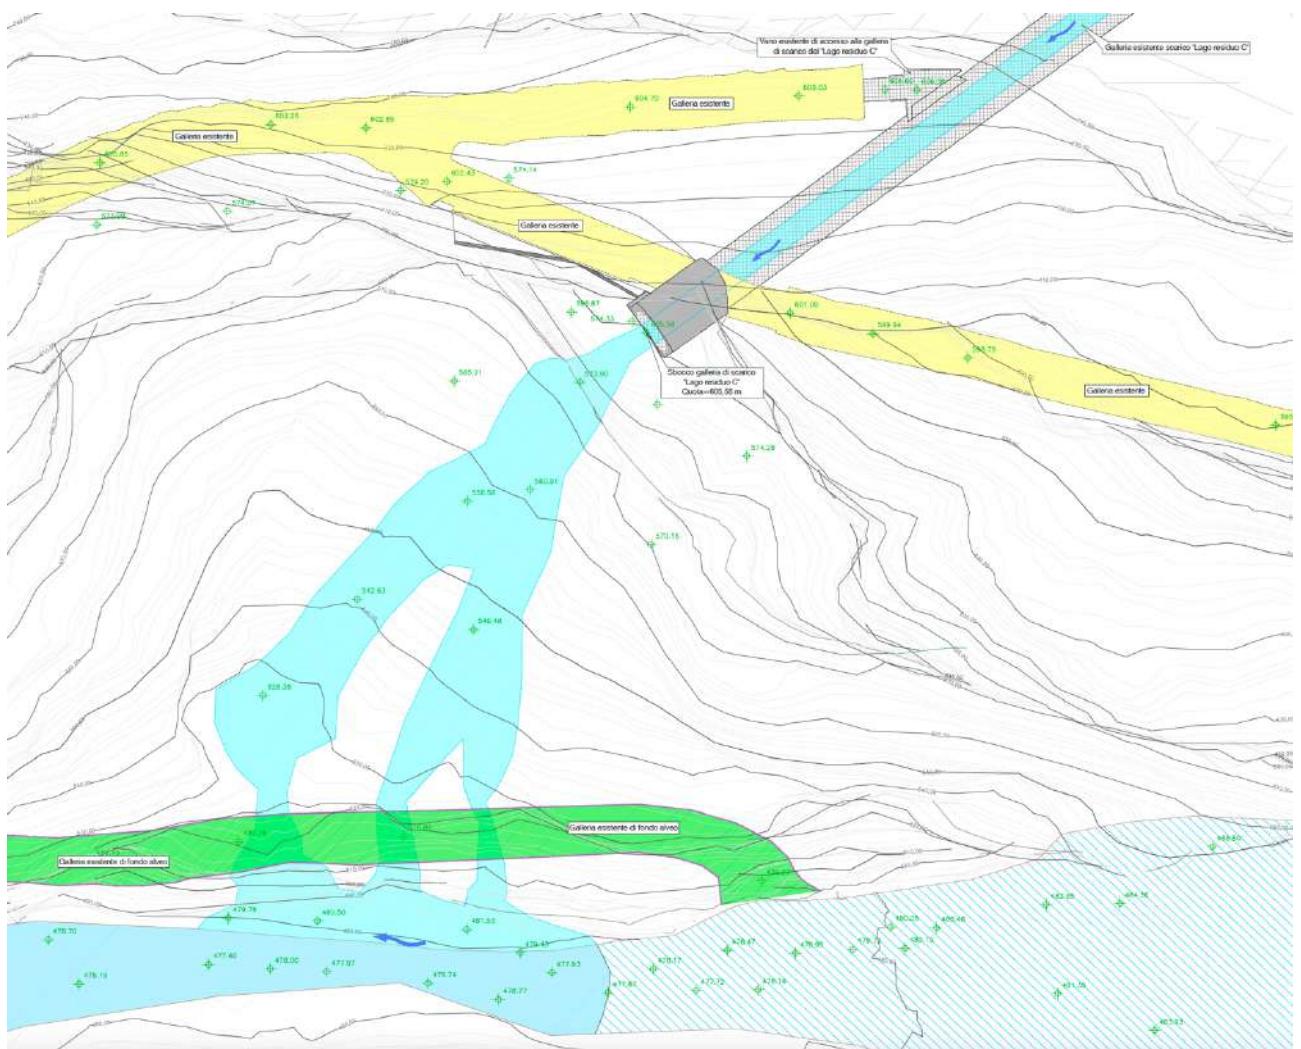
Planimetria allo stato di fatto delle opere esistenti con evidenziata la galleria di by pass e le gallerie di accesso (in giallo) (in verde la galleria ai piedi della forra)
